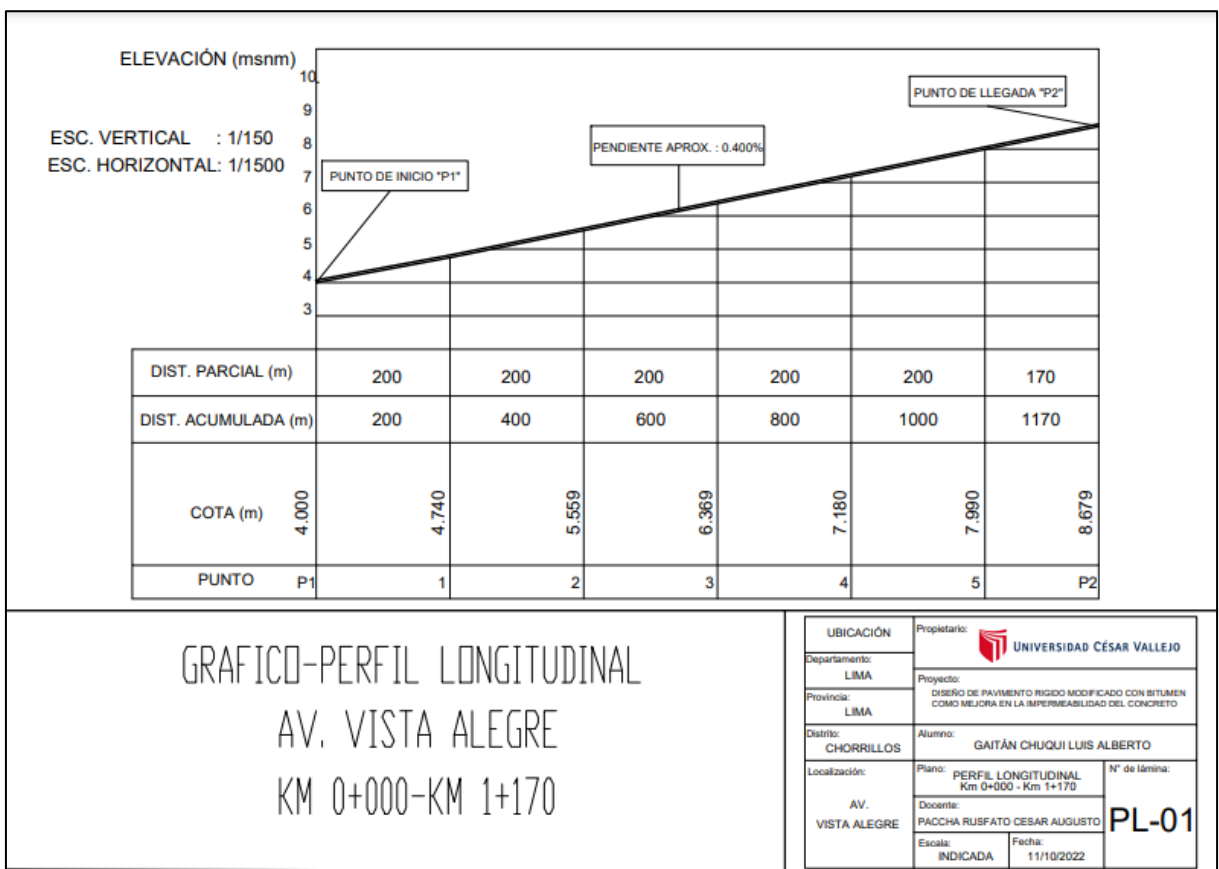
Plano de perfil Longitudinal Av. Vista Alegre.
